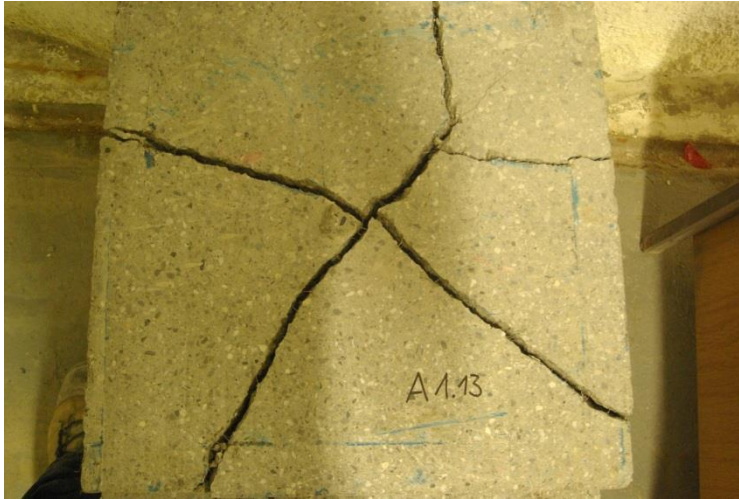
Typisches Rissbild an einer bis zu starker Deformation geprüften Stahlfaserspritzbetonplatte
